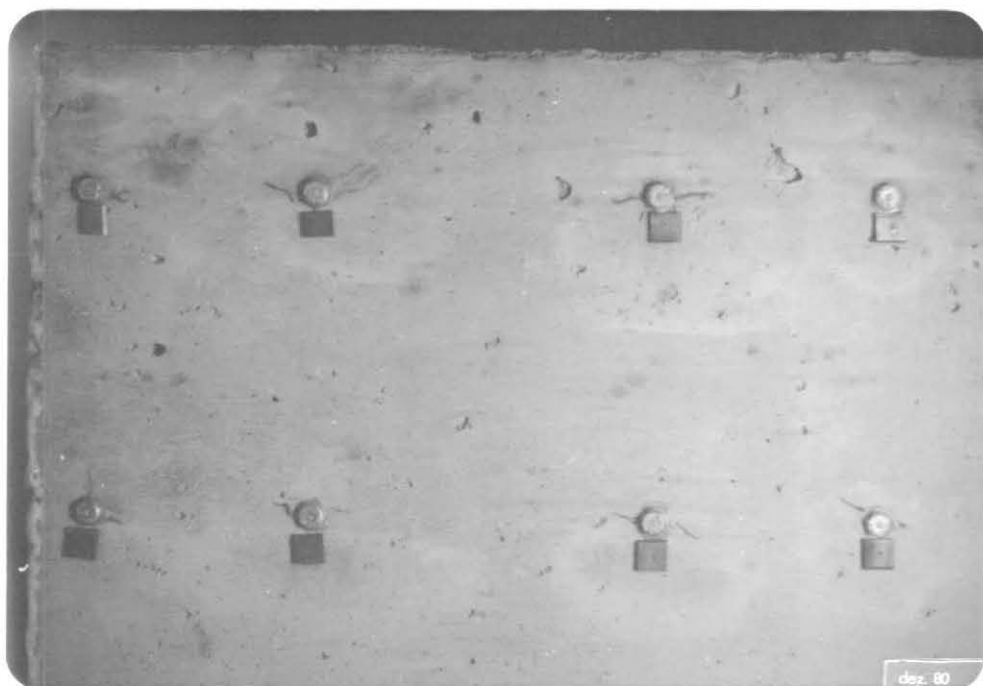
Visão geral da fissuração ocorrida em torno das referências chumbadas e posicionamento das chapinhas coladas no concreto
